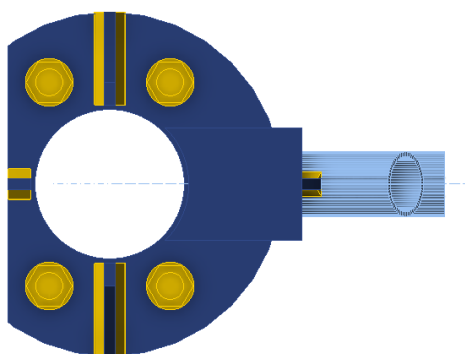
Розріз монтажного стыку нижнього поясу просторового блоку ферми
